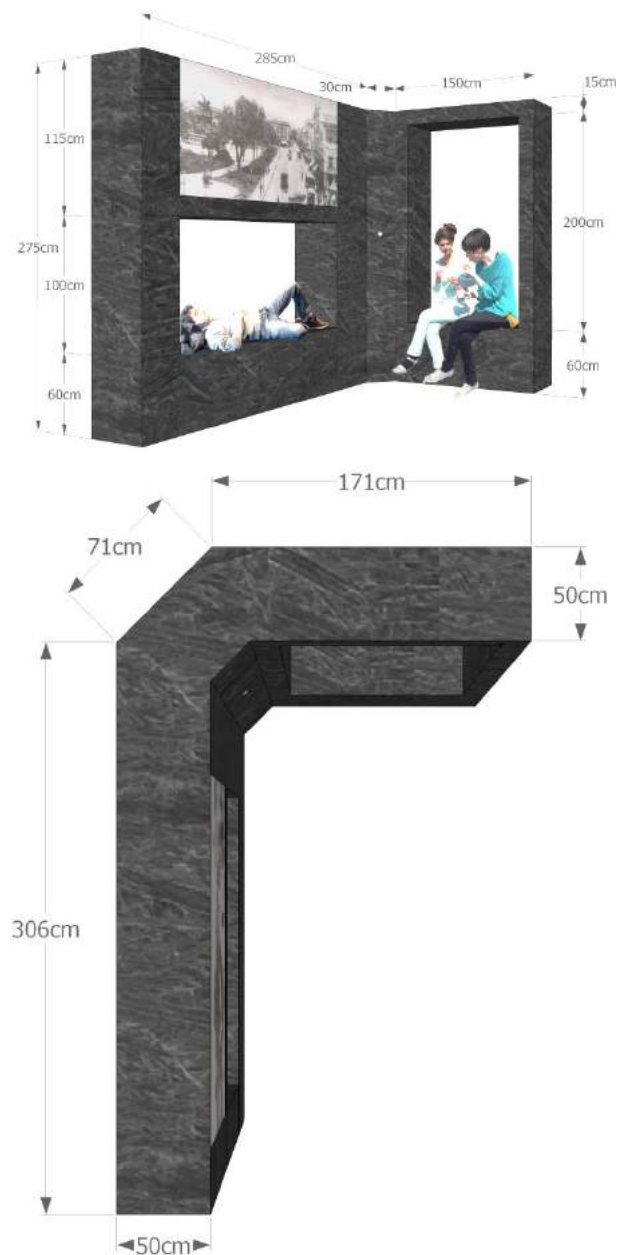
e 89: Perspectiva e planta baixa da instalação.
